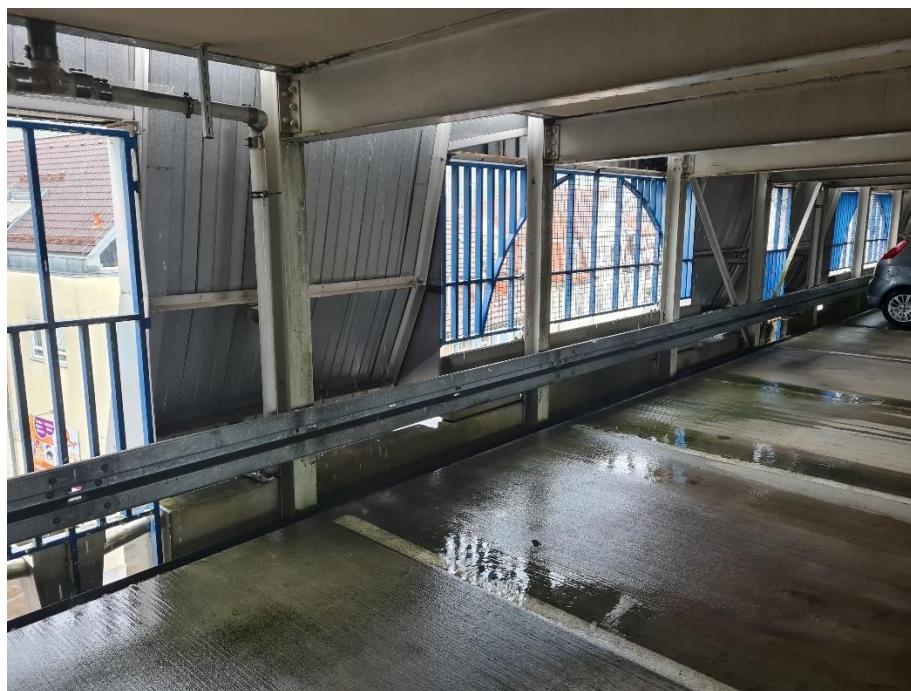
Offene Fassadenstruktur mit Freibewitterung der Parkdeck-Randbereiche
